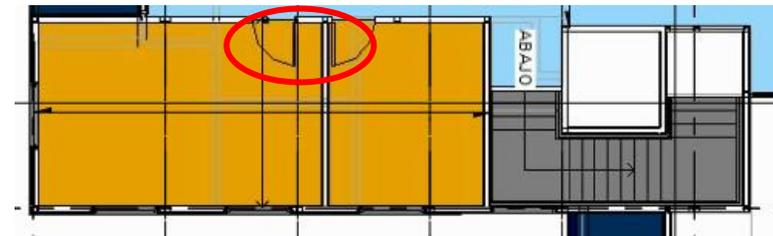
Planta segunda modificada zona del ascensor. Elaboración propia.
